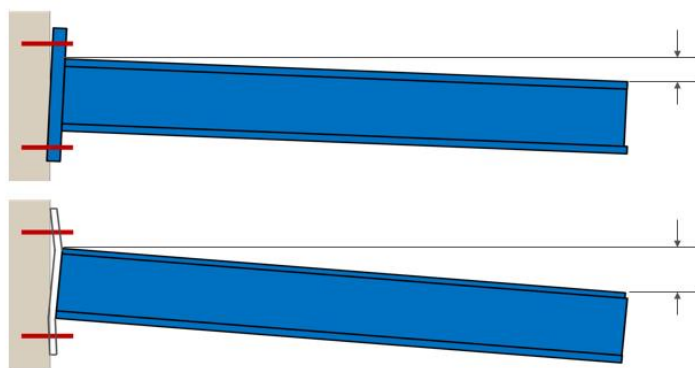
Spostamento della trave a sbalzo in caso di piastra di base rigida e non rigida
